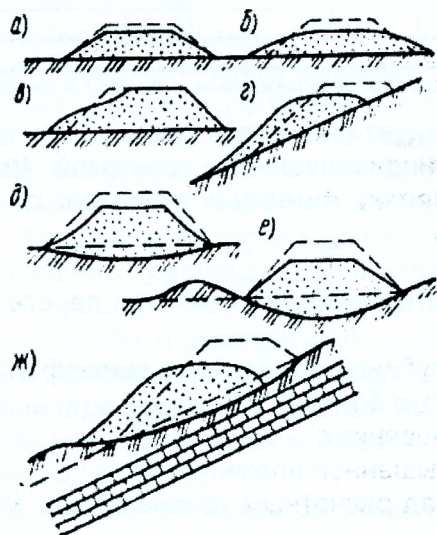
Виды деформаций насыпей: а – осадка от уплотнения грунта в теле насыпи; б – деформация осадки от растекания переувлажненного грунта; в – оползание откоса насыпи; г – сползание насыпи по косогору; д – осадка со сжатием грунта основания; е – осадка, а иногда боковое смещение, из-за выжимания слабого основания; ж – смещение из-за оползания склона
